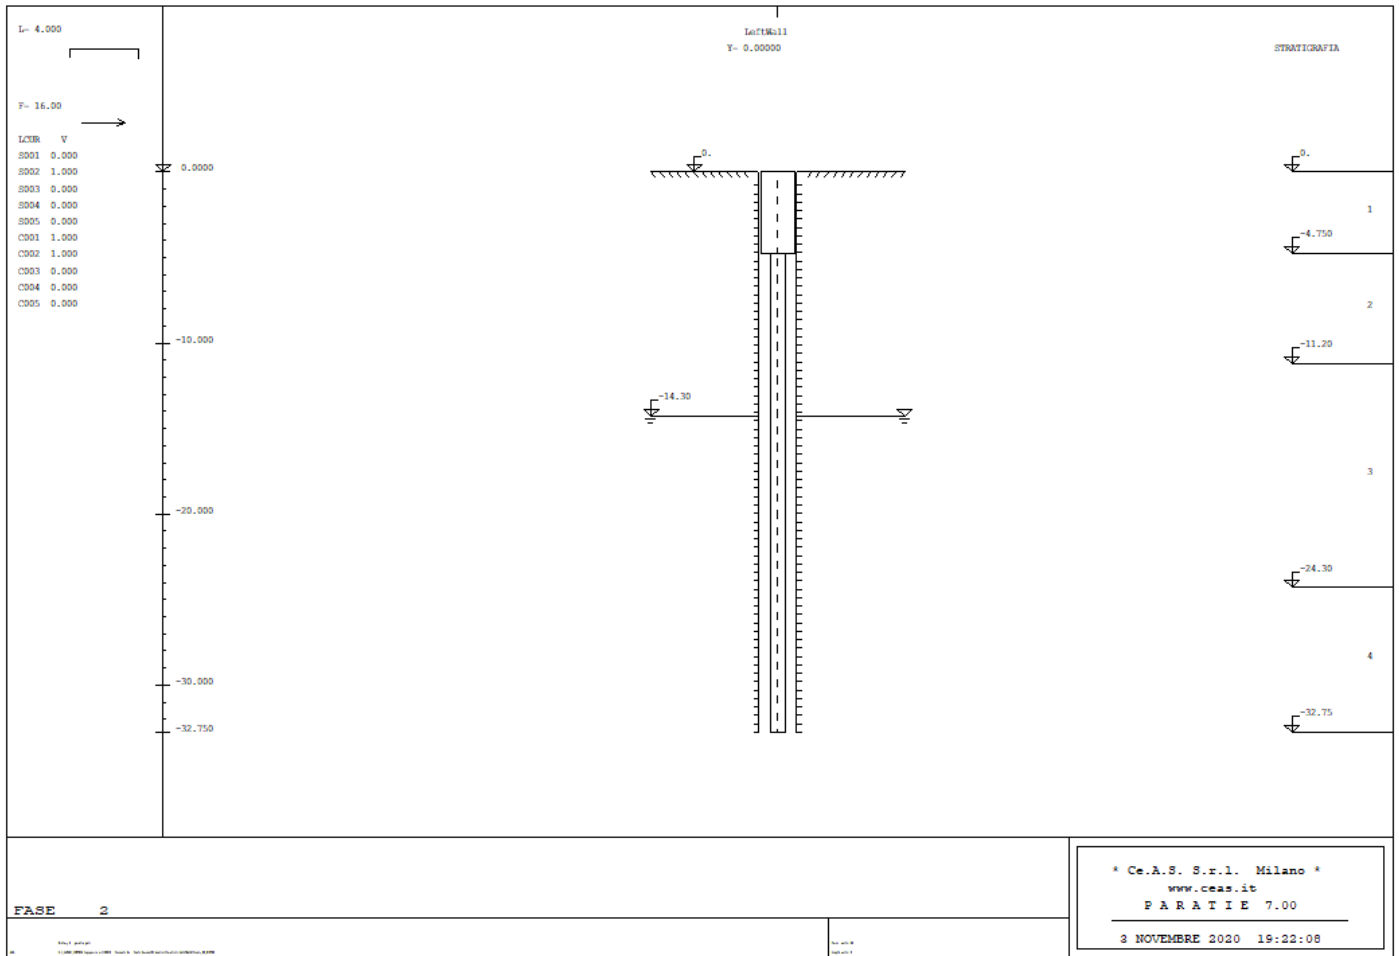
Fase 2 – Realizzazione paratia e muro corpo spalla
